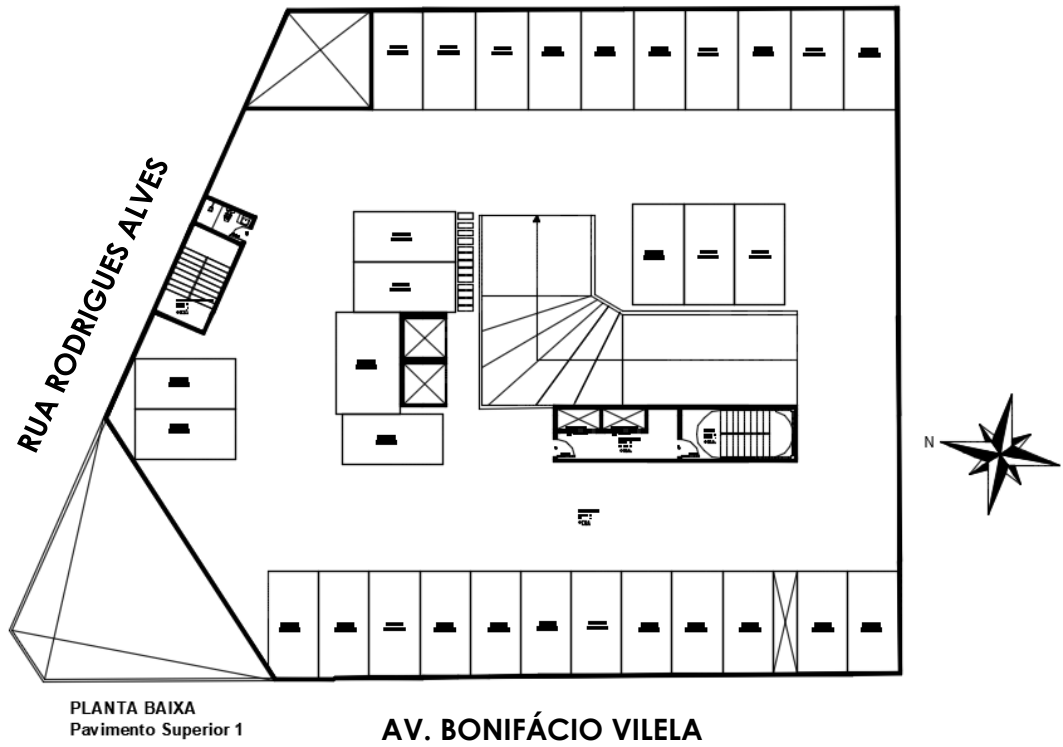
Projeto Arquitetônico – Pavimento Superior 1-2-3
